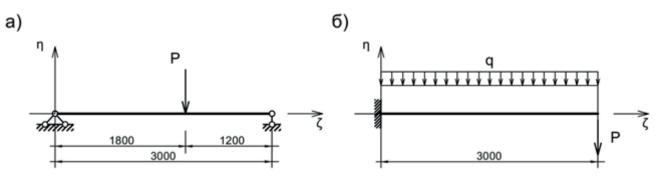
Расчётные схемы балок. а) Балка №1; б) Балка №2.
